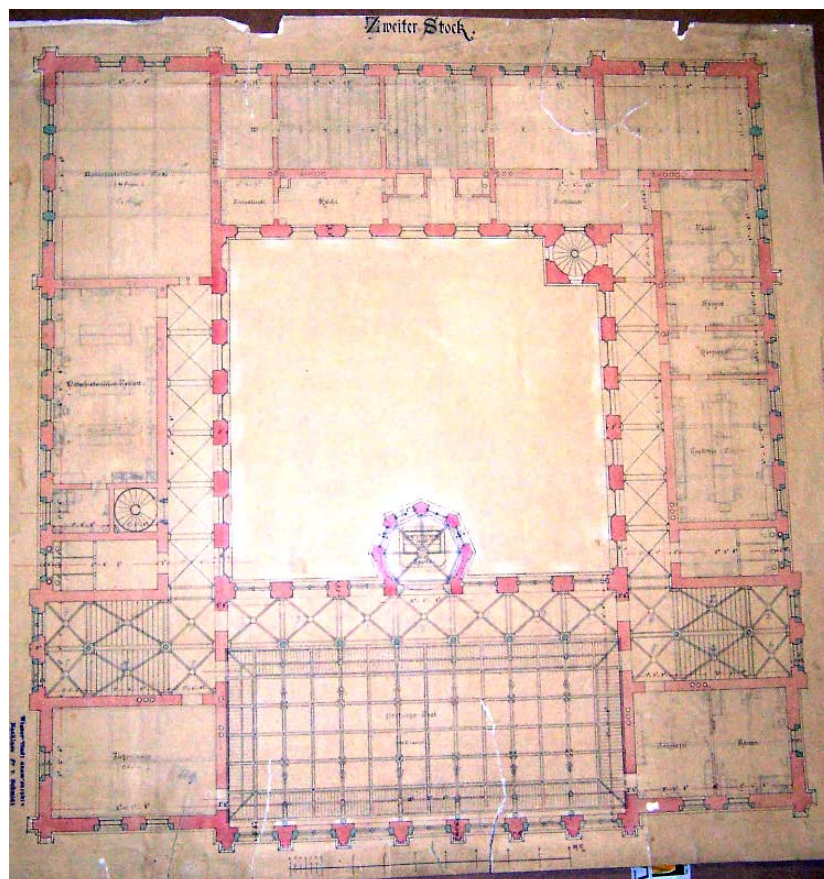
Grundrissplan, zweiter Stock, nach 1862
